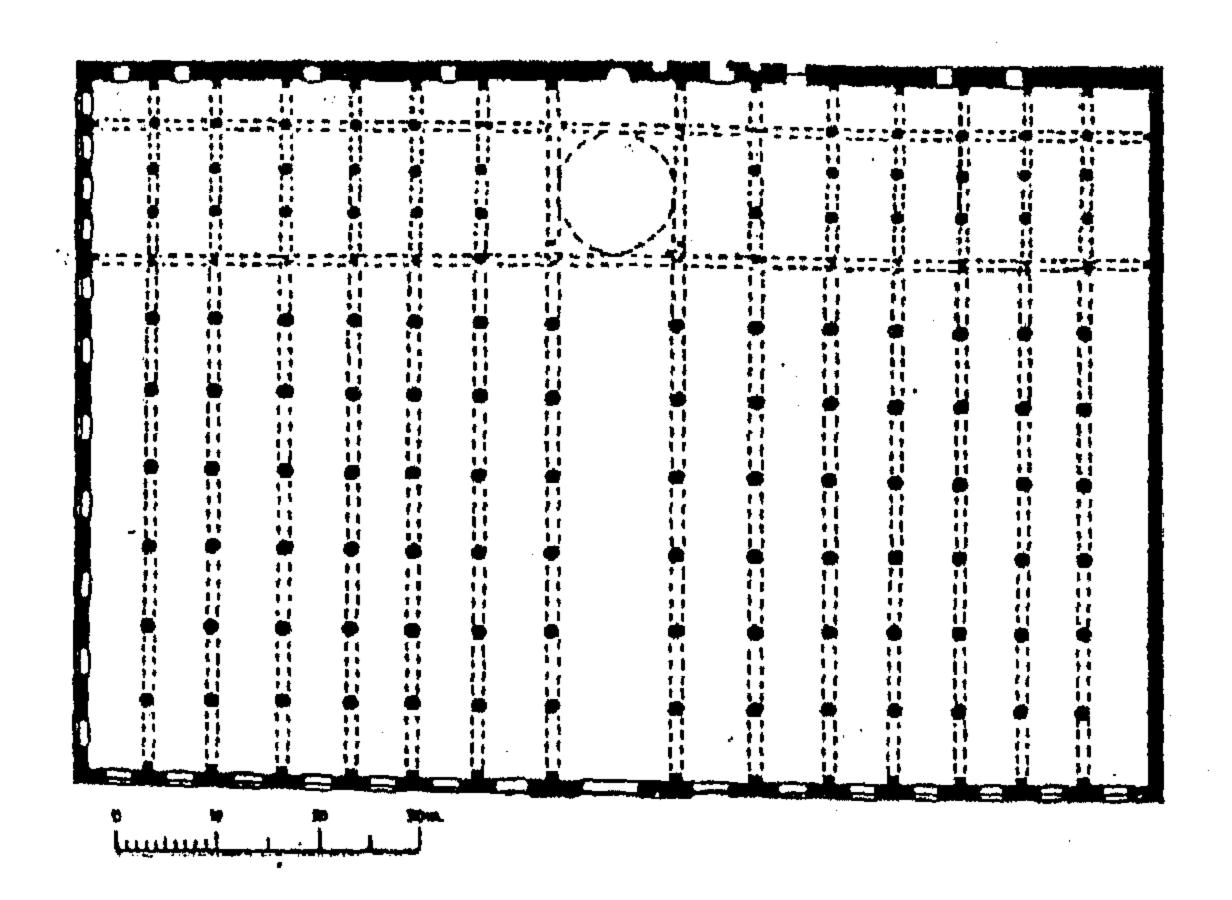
مسقط أفقي لمسجد طاش بقونية في تركيا (٦١٢هـ/١٢٥م) . (عن : Aslanapa) .
